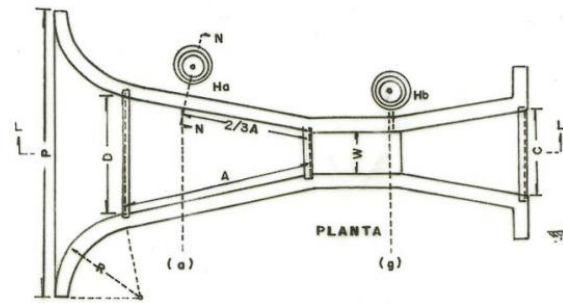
Dimensiones en planta de la canaleta Parshall (Marbello, 2005)
